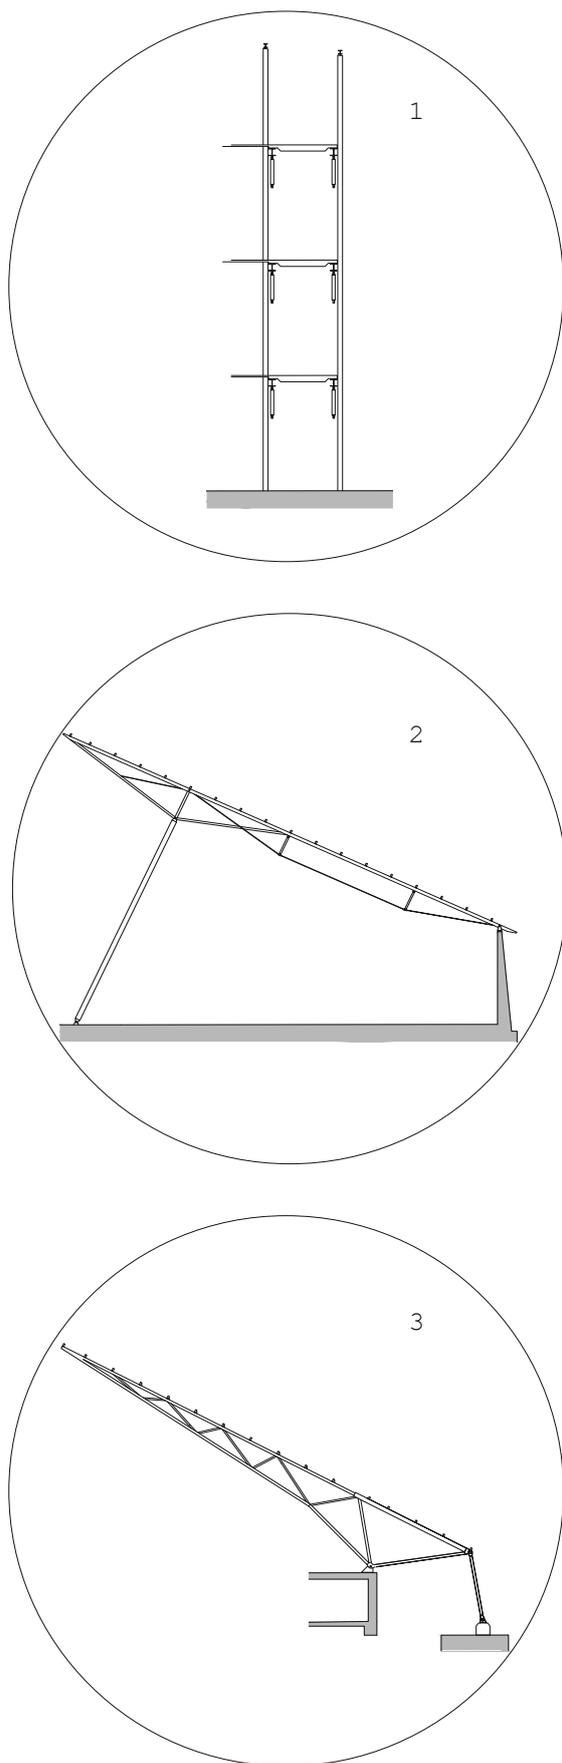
Schnitt Tragkonstruktion (aufgeteilt)
